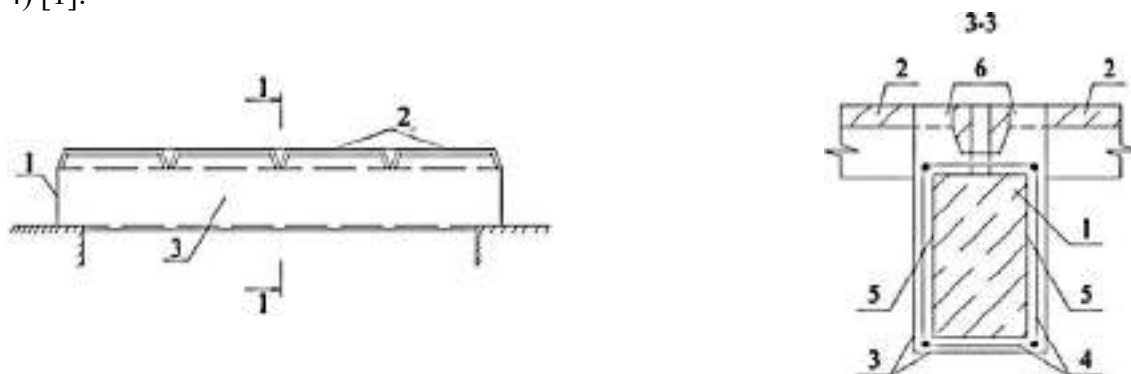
Устройство фибробетонной обоймы железобетонной балки:
